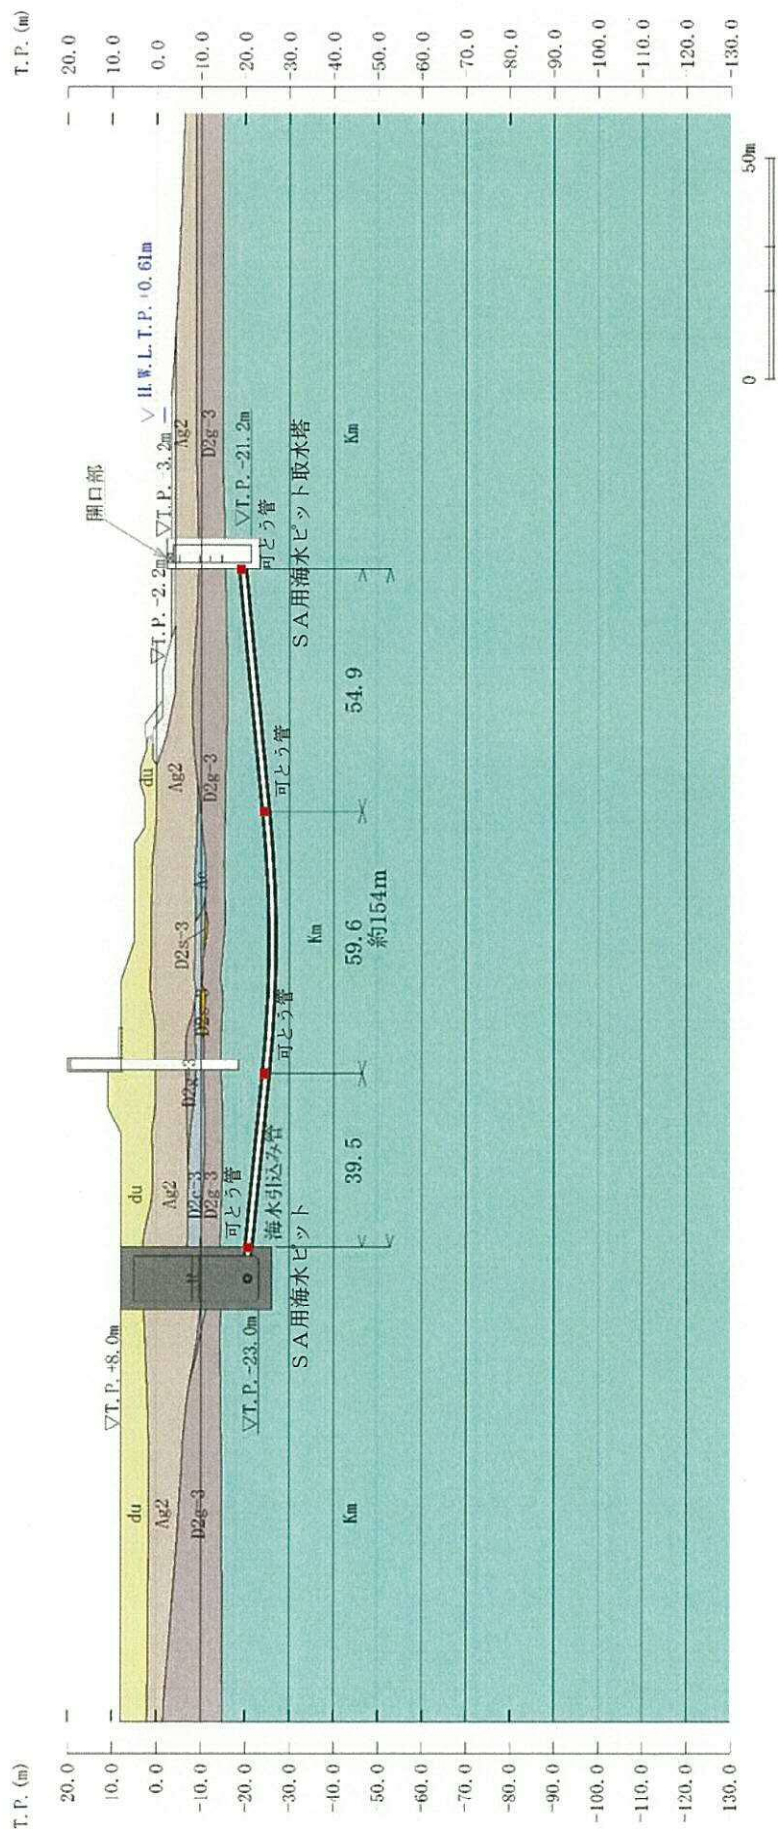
(1) SA用海水ピット 評価対象断面図 (①-①断面)
